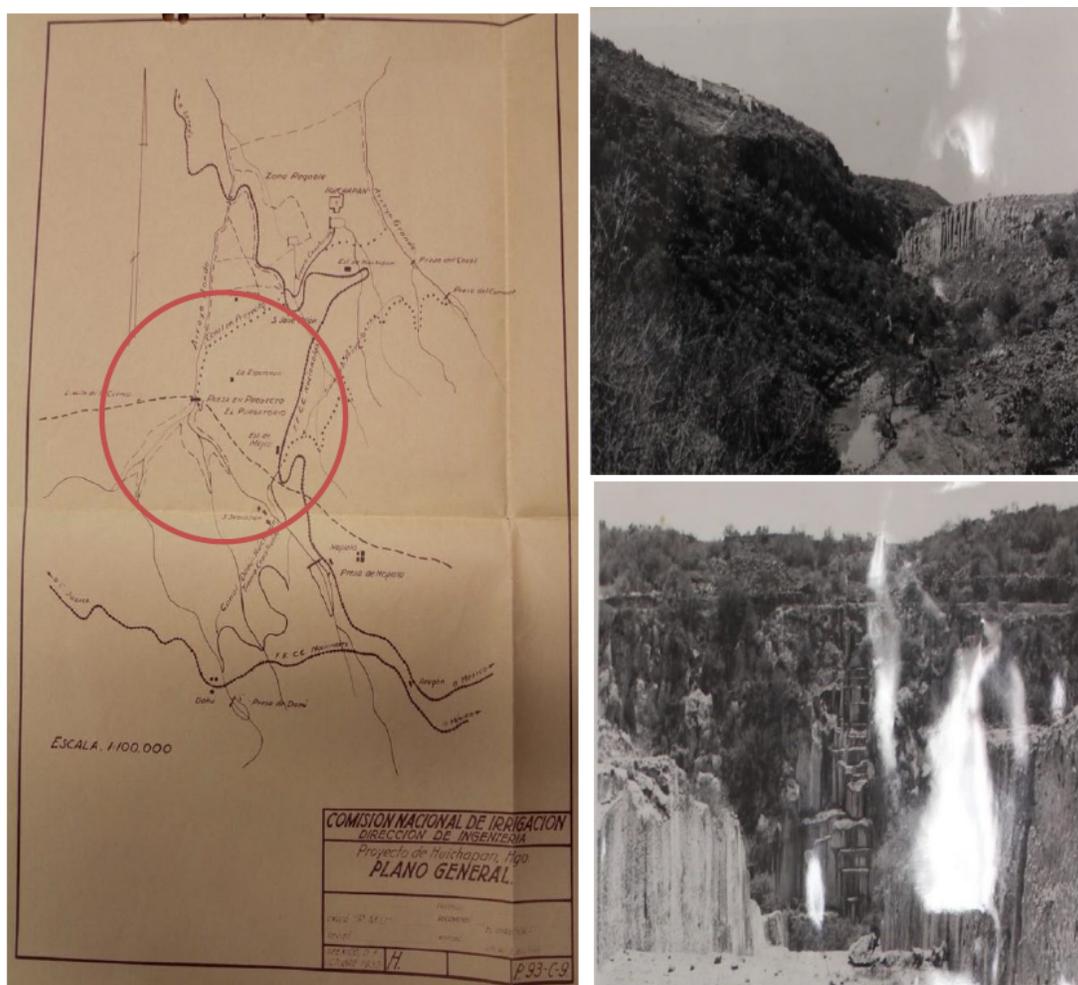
Plano general de la presa y trabajos de construcción de la presa “El Purgatorio”.
